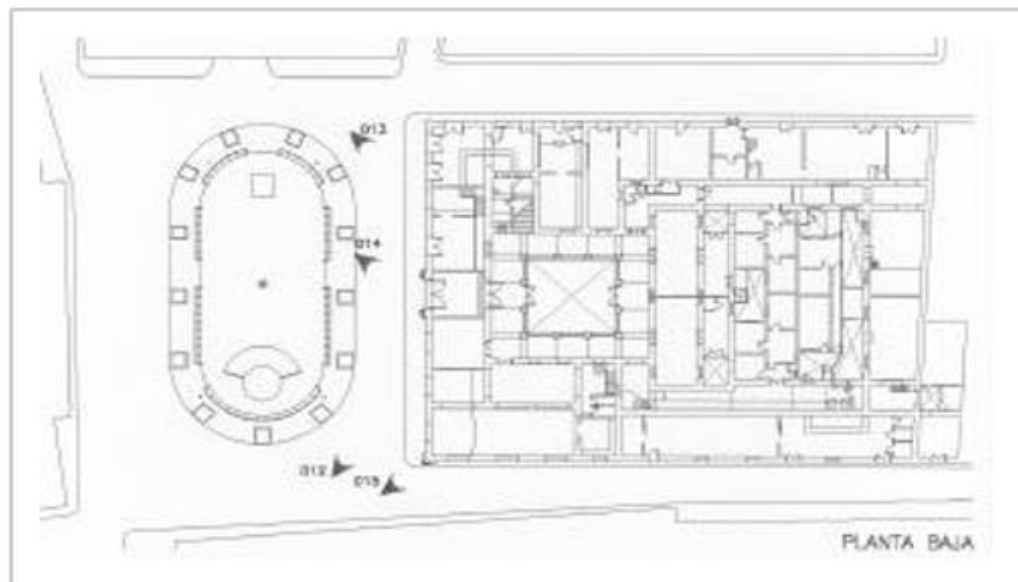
Plano de la planta y plaza del Pumarejo. Carmen Guerra de Hoyos arquitecta, 2002<sup>834</sup>.
